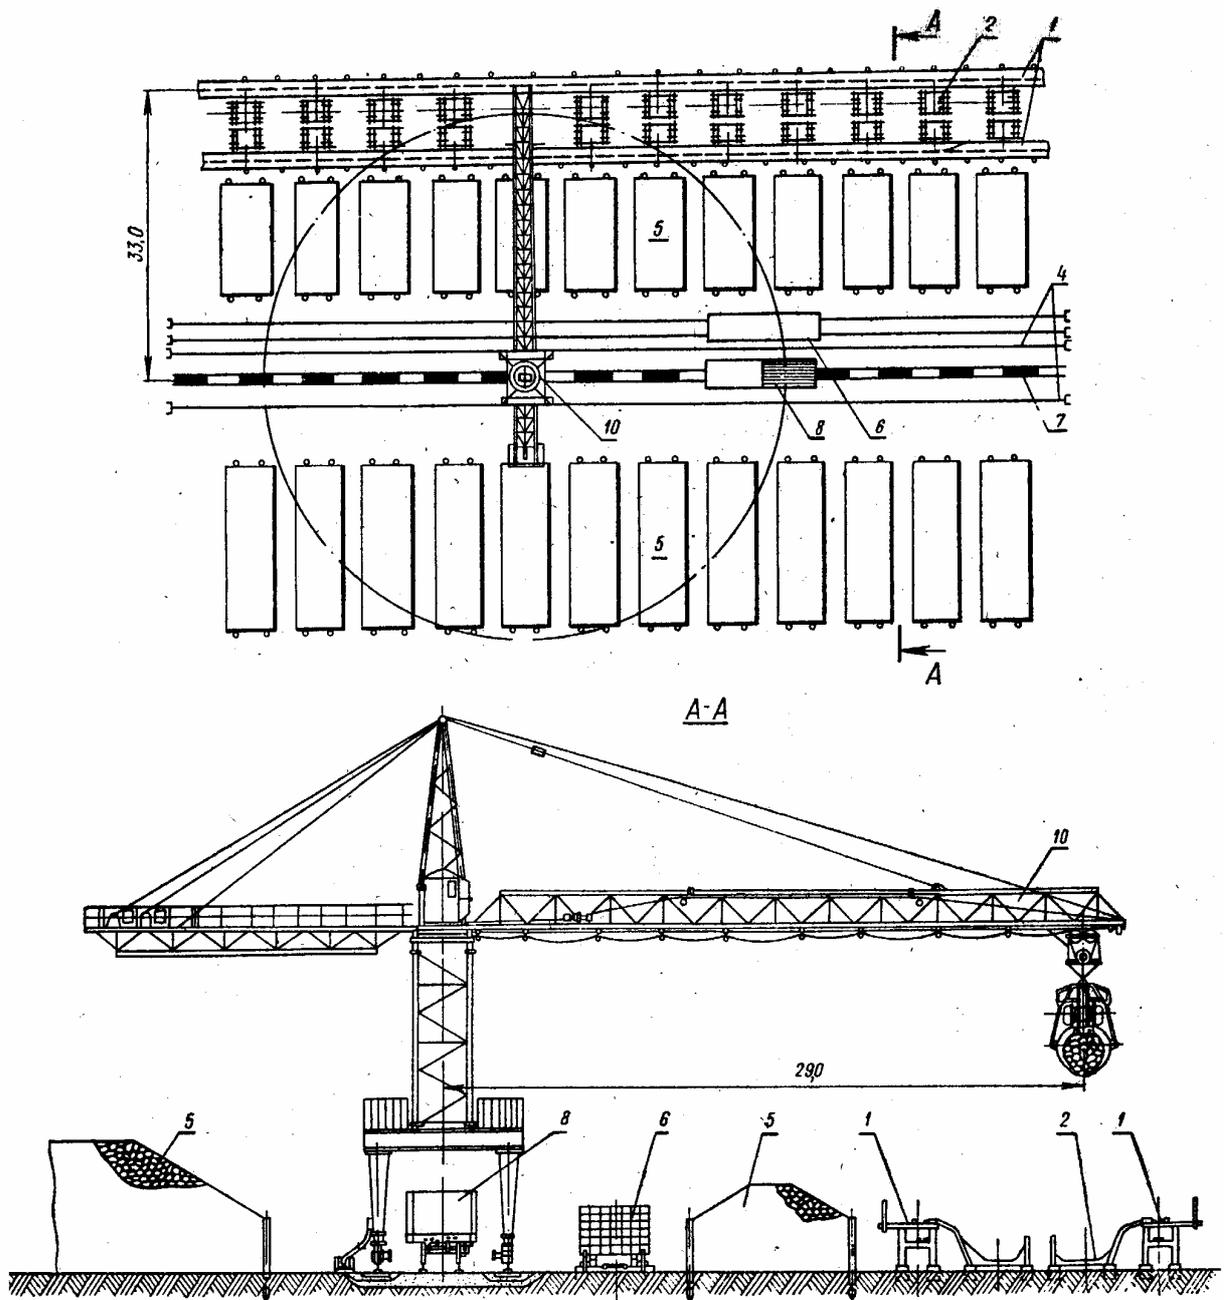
Сортировка круглых лесоматериалов продольным транспортером, штабелевка и погрузка башенным краном КБ-572А
